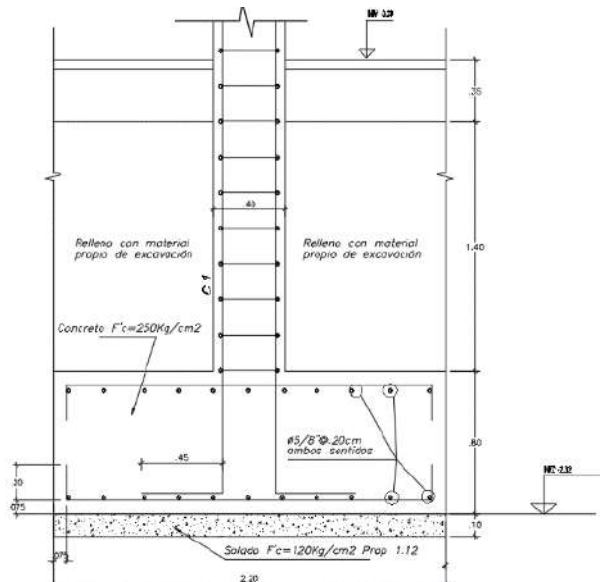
Corte de zapata donde se muestra la profundidad de cimentación de 1.75m, elaboración prima
